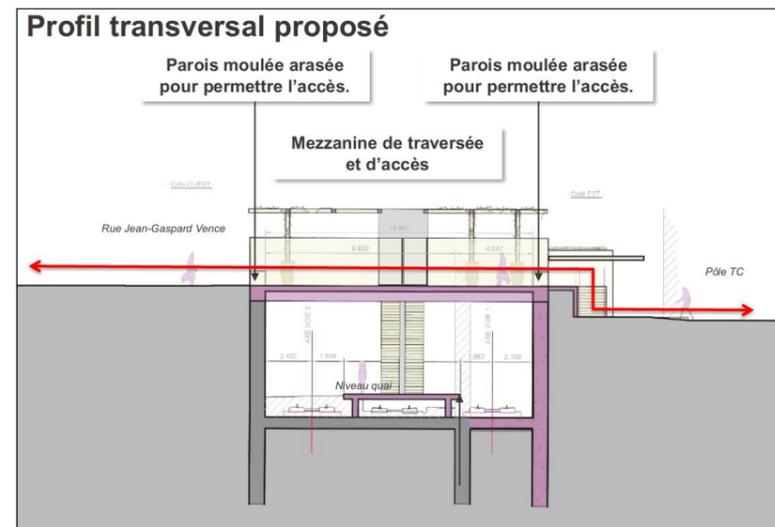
Profil en travers de la halte d'Arenc. La nouvelle paroi est figurée en violet (Source : AREP, 2021)
